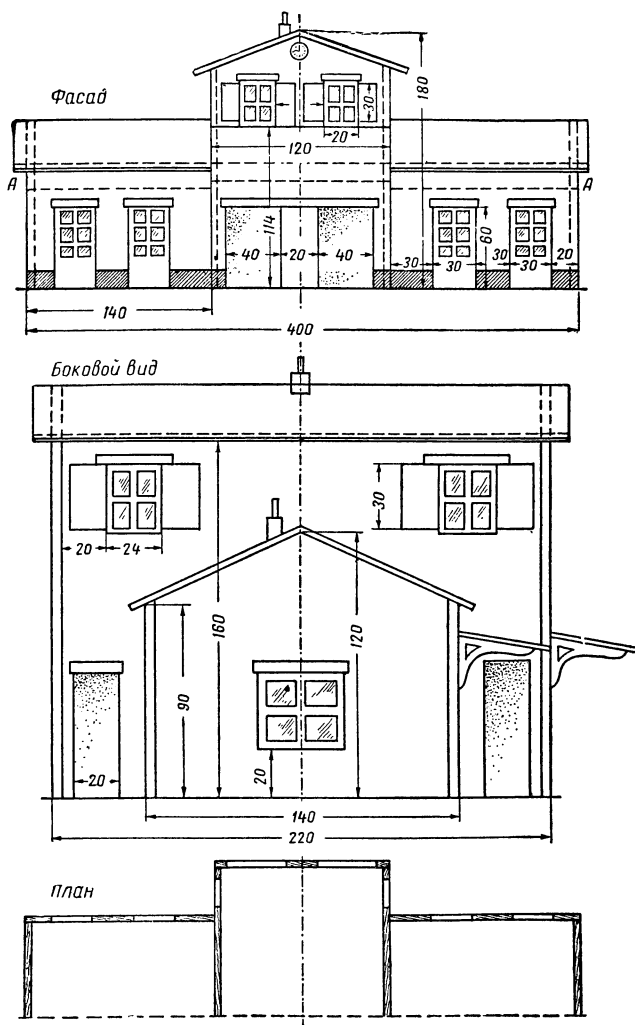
Фасад, боковой вид и разрез маленького вокзала.
